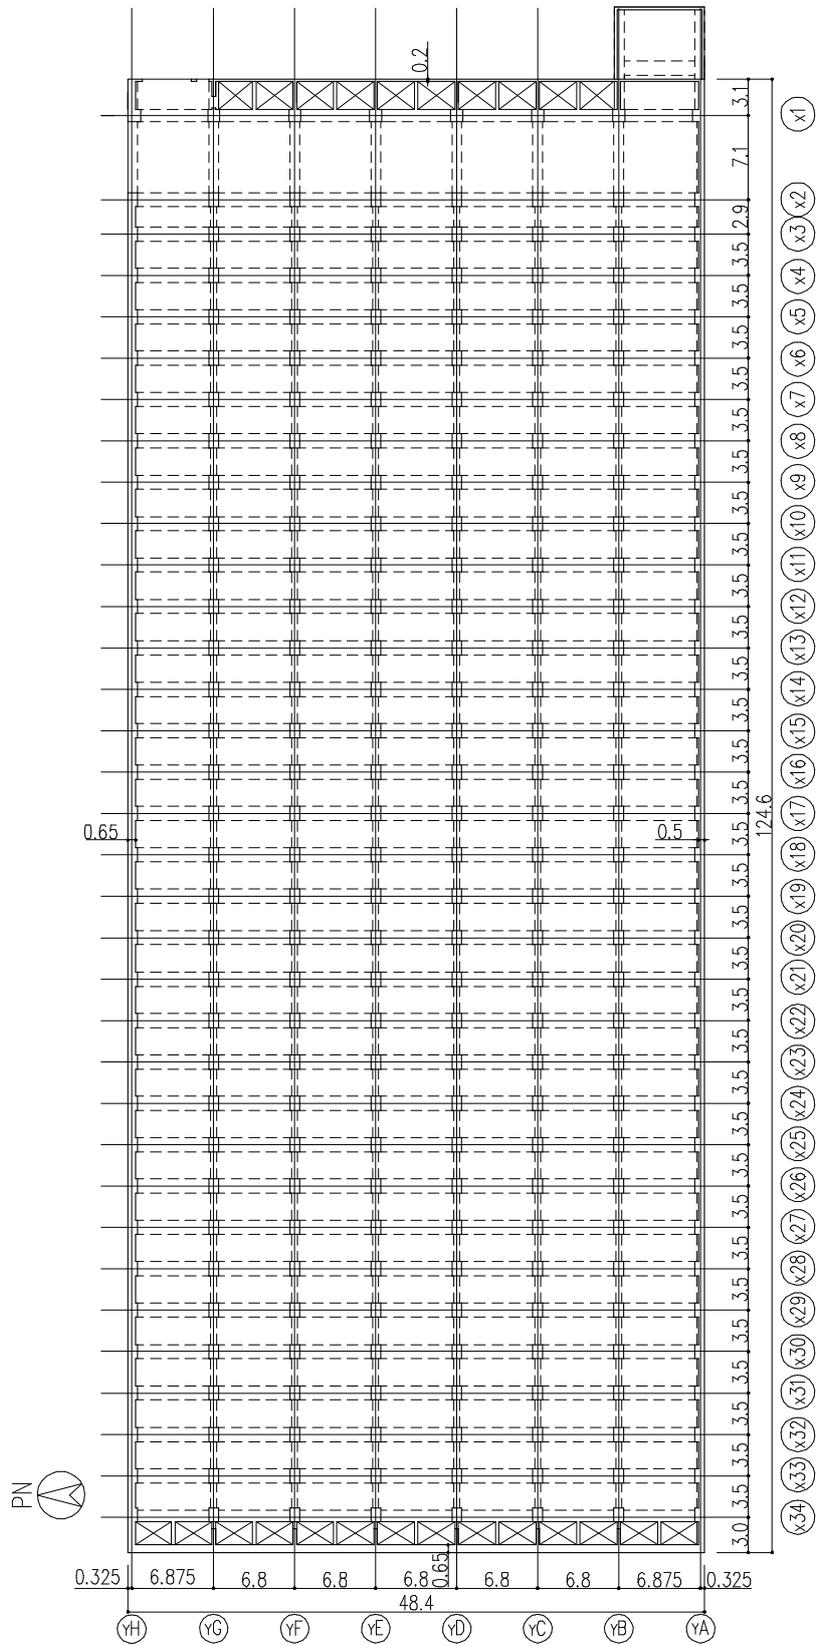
杭配置図 (G.L. -11.0) (单位 : m)
